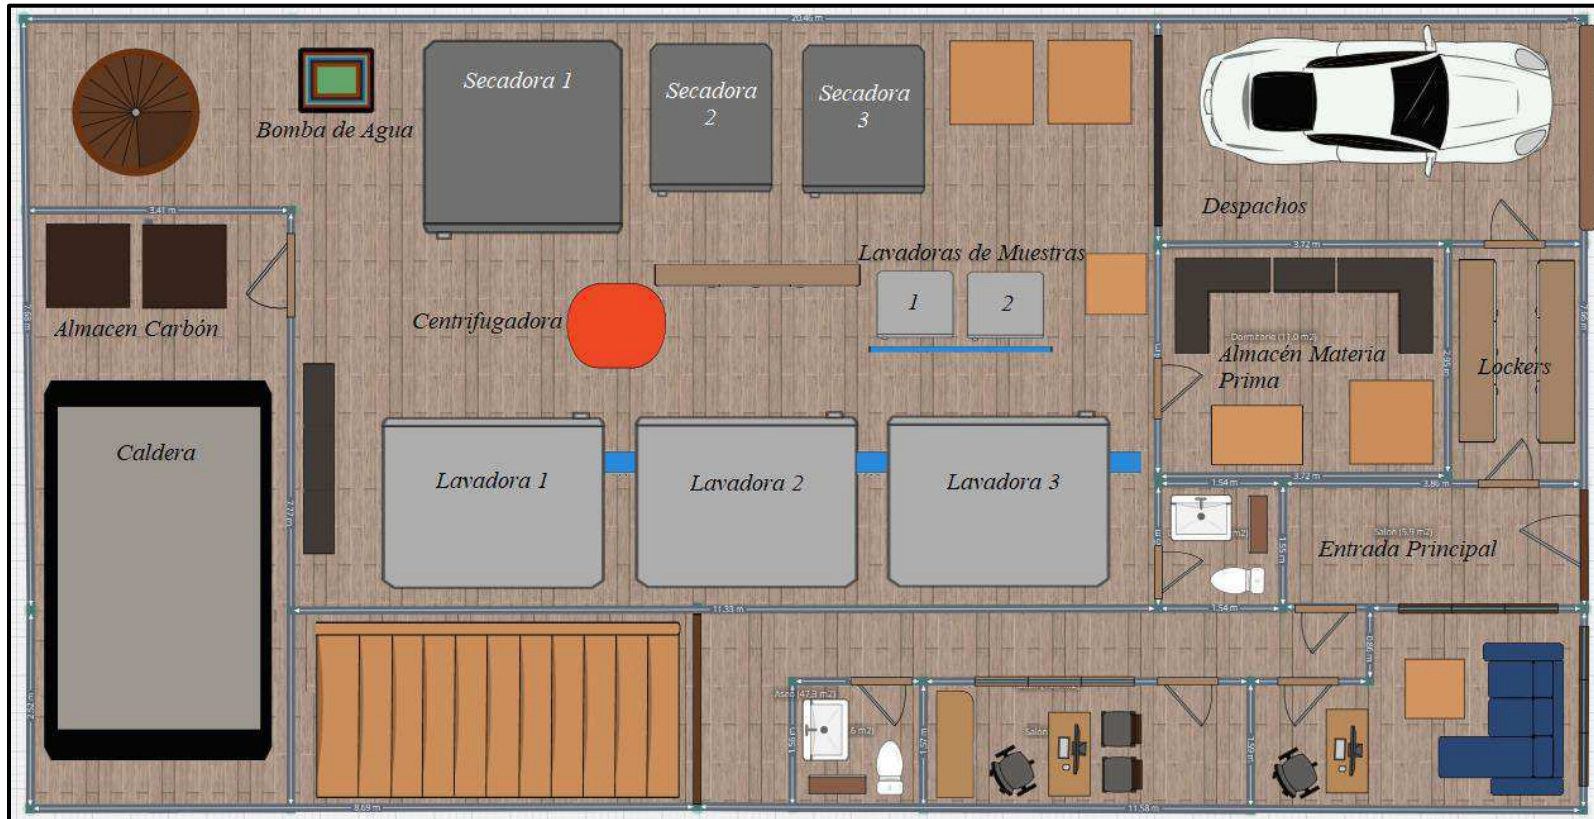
Distribución planta 1er nivel. Nota: Autoría propia.
